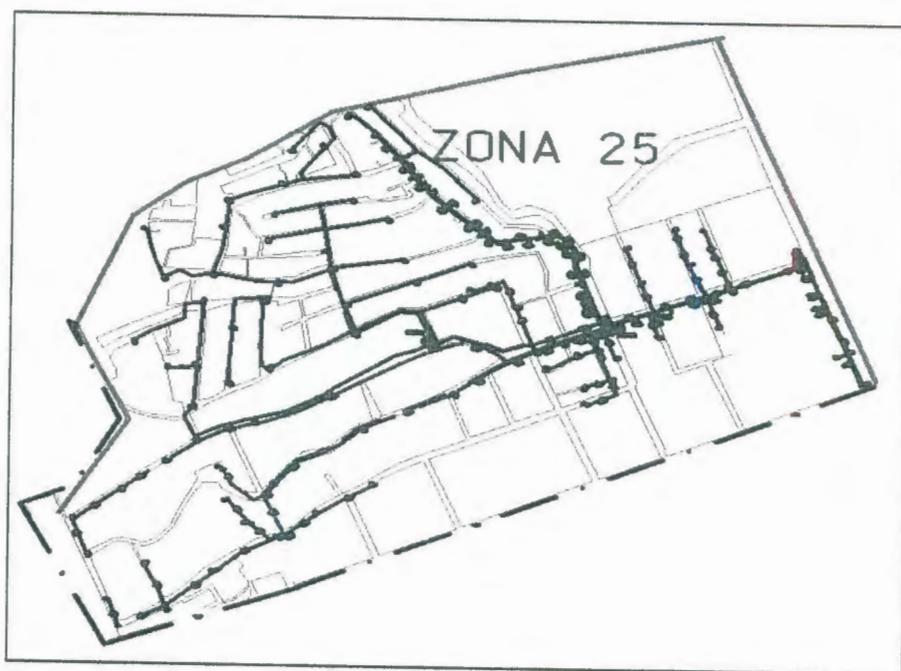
Planimetría zona 25 del sector de la vía a Daule
